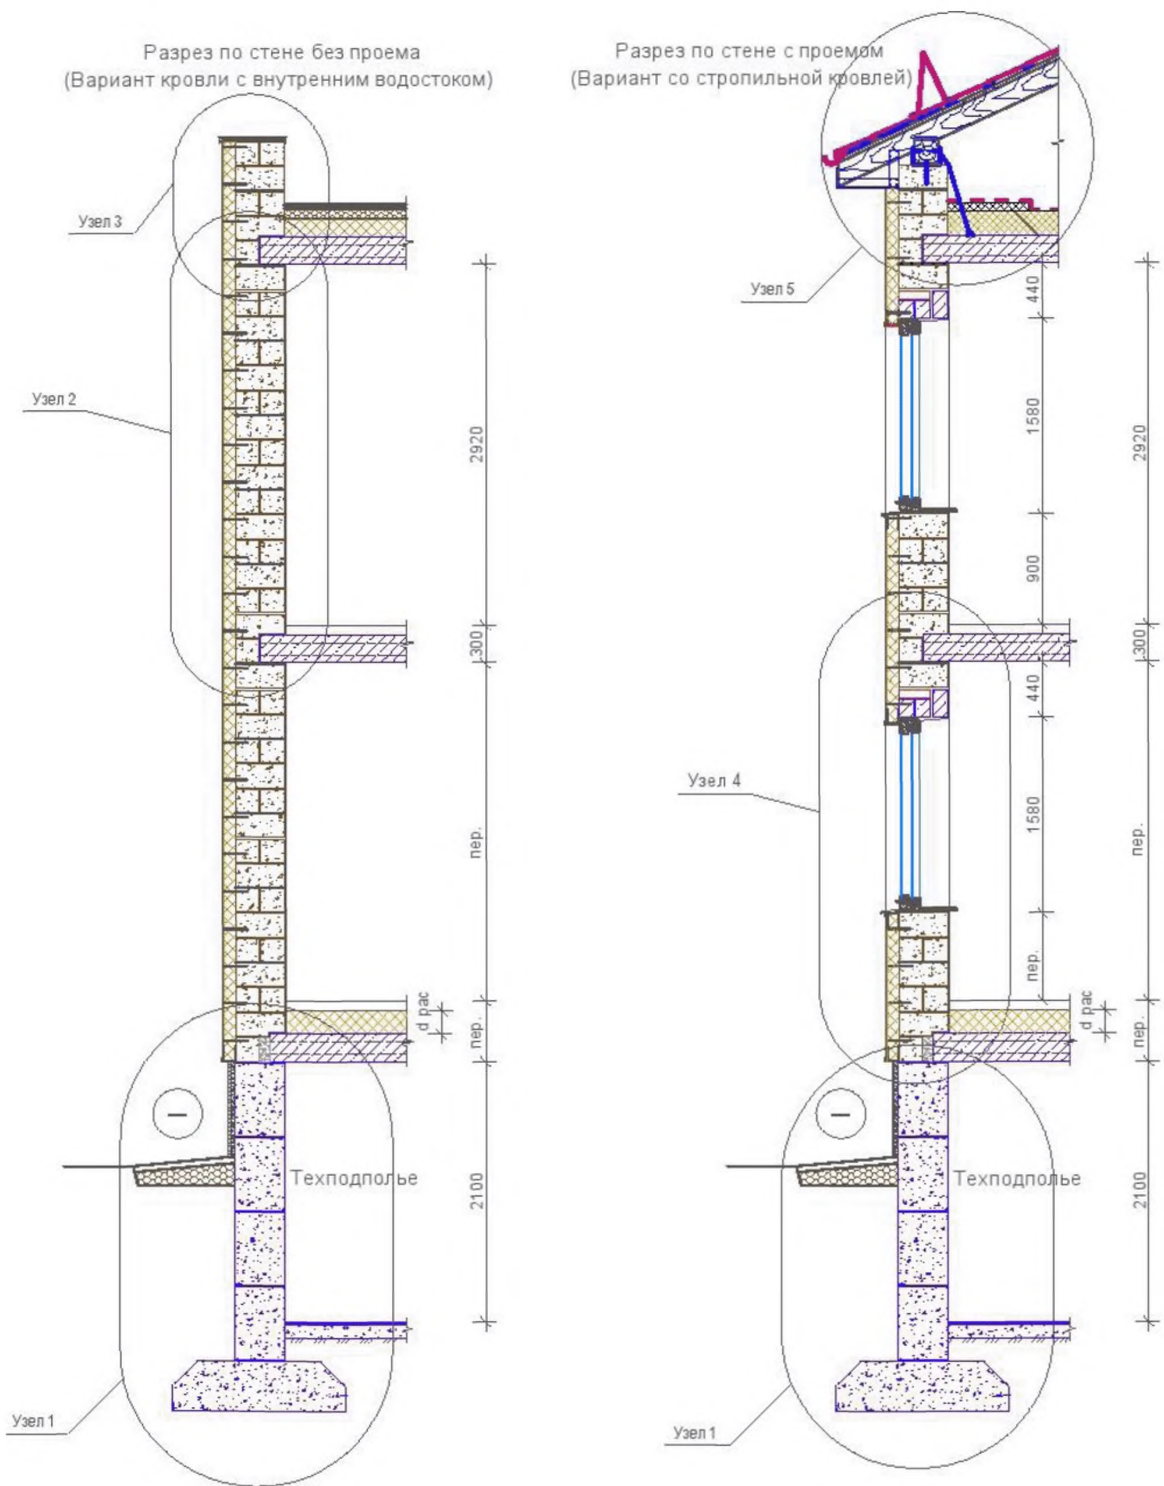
Схема нумерации узлов на поперечном разрезе здания
